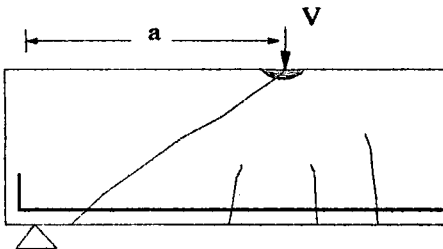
Kayma donatısız bir betonarme kirişin davranışı.
